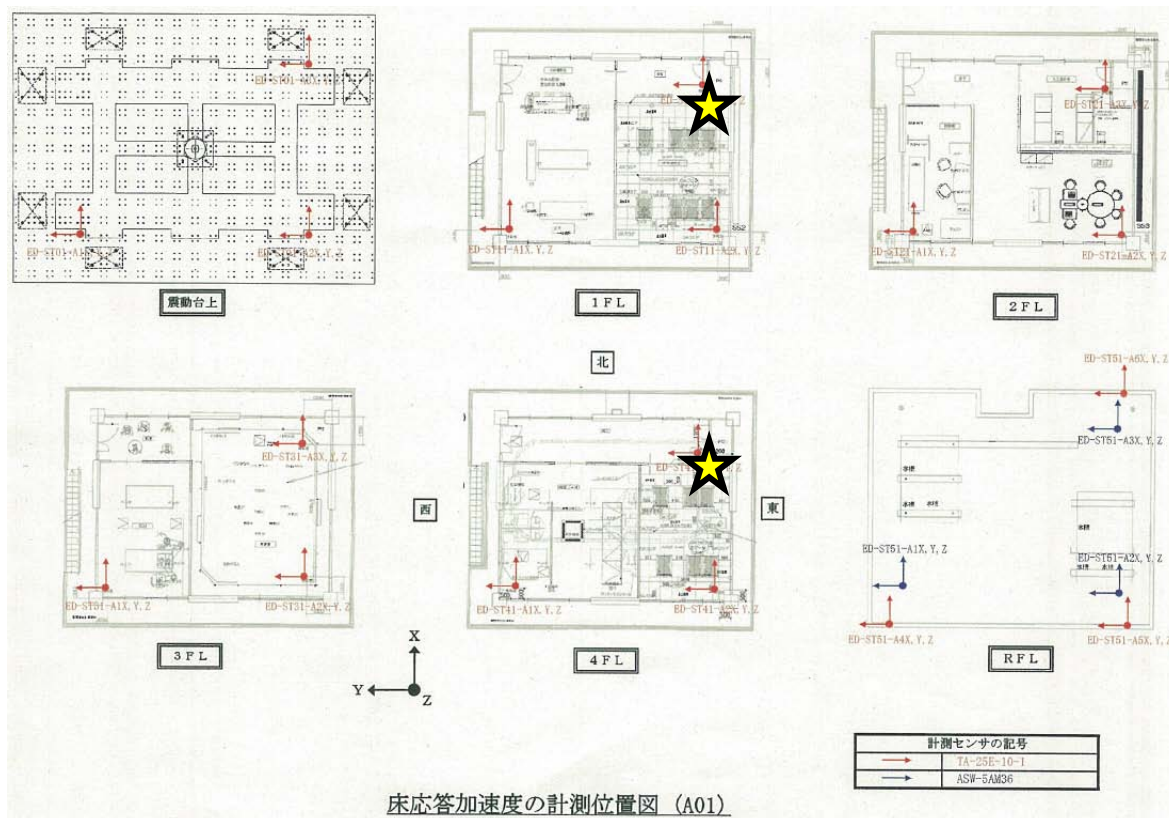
試験体の平面図及びスマートセンサの設置箇所
